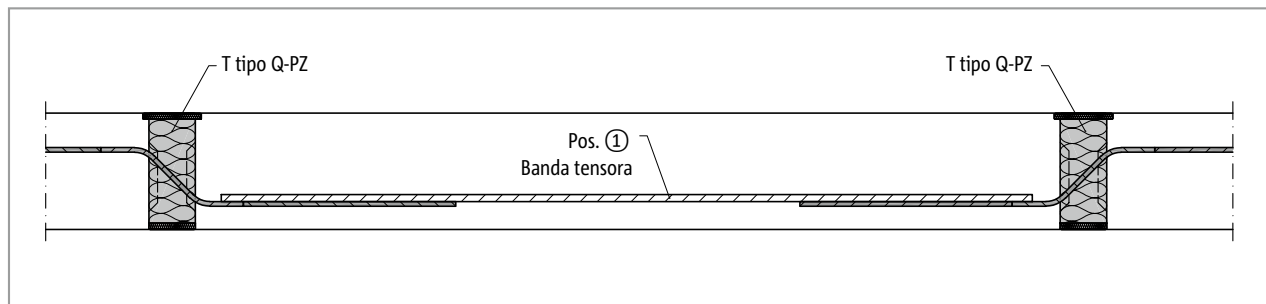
Schöck Isokorb® T tipo Q-PZ: Conexión de la armadura, banda tensora
